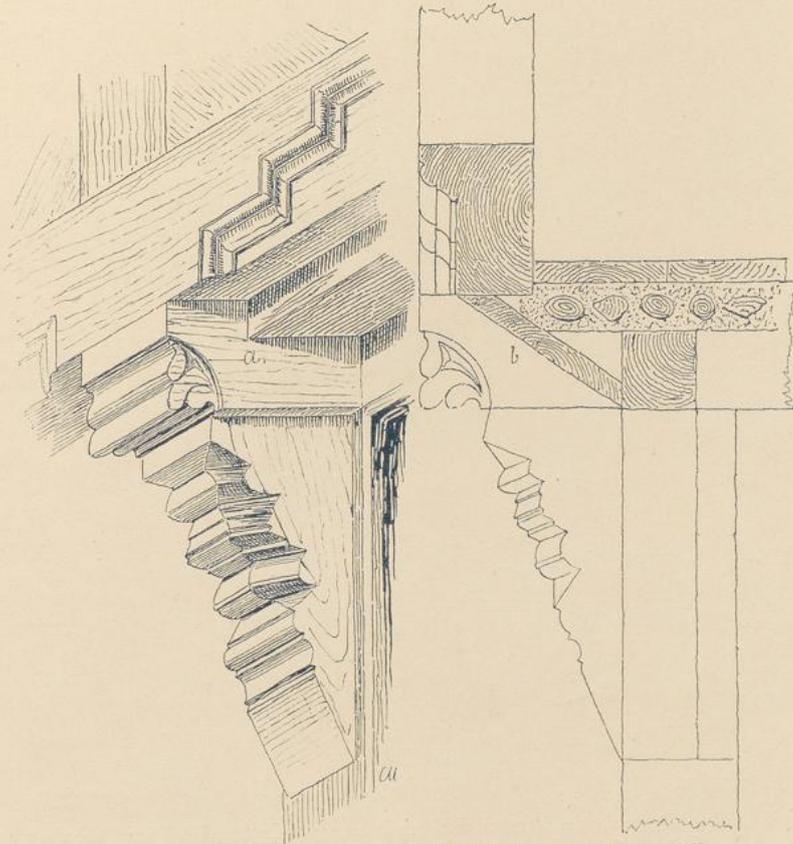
Treppenfriesschwelle und Knagge, älteste Form. Braunschweig 1450-1490.
